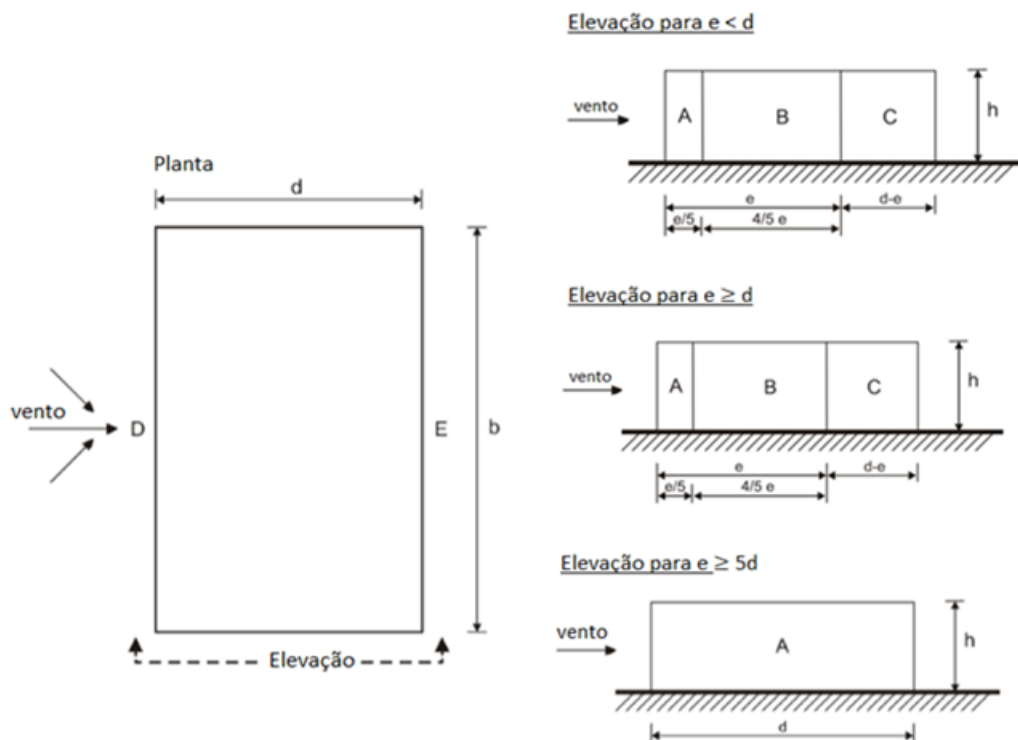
Aplicação do vento e zonas em paredes verticais (adaptado de EN 1991-1-4 /7.2.2) [13]
